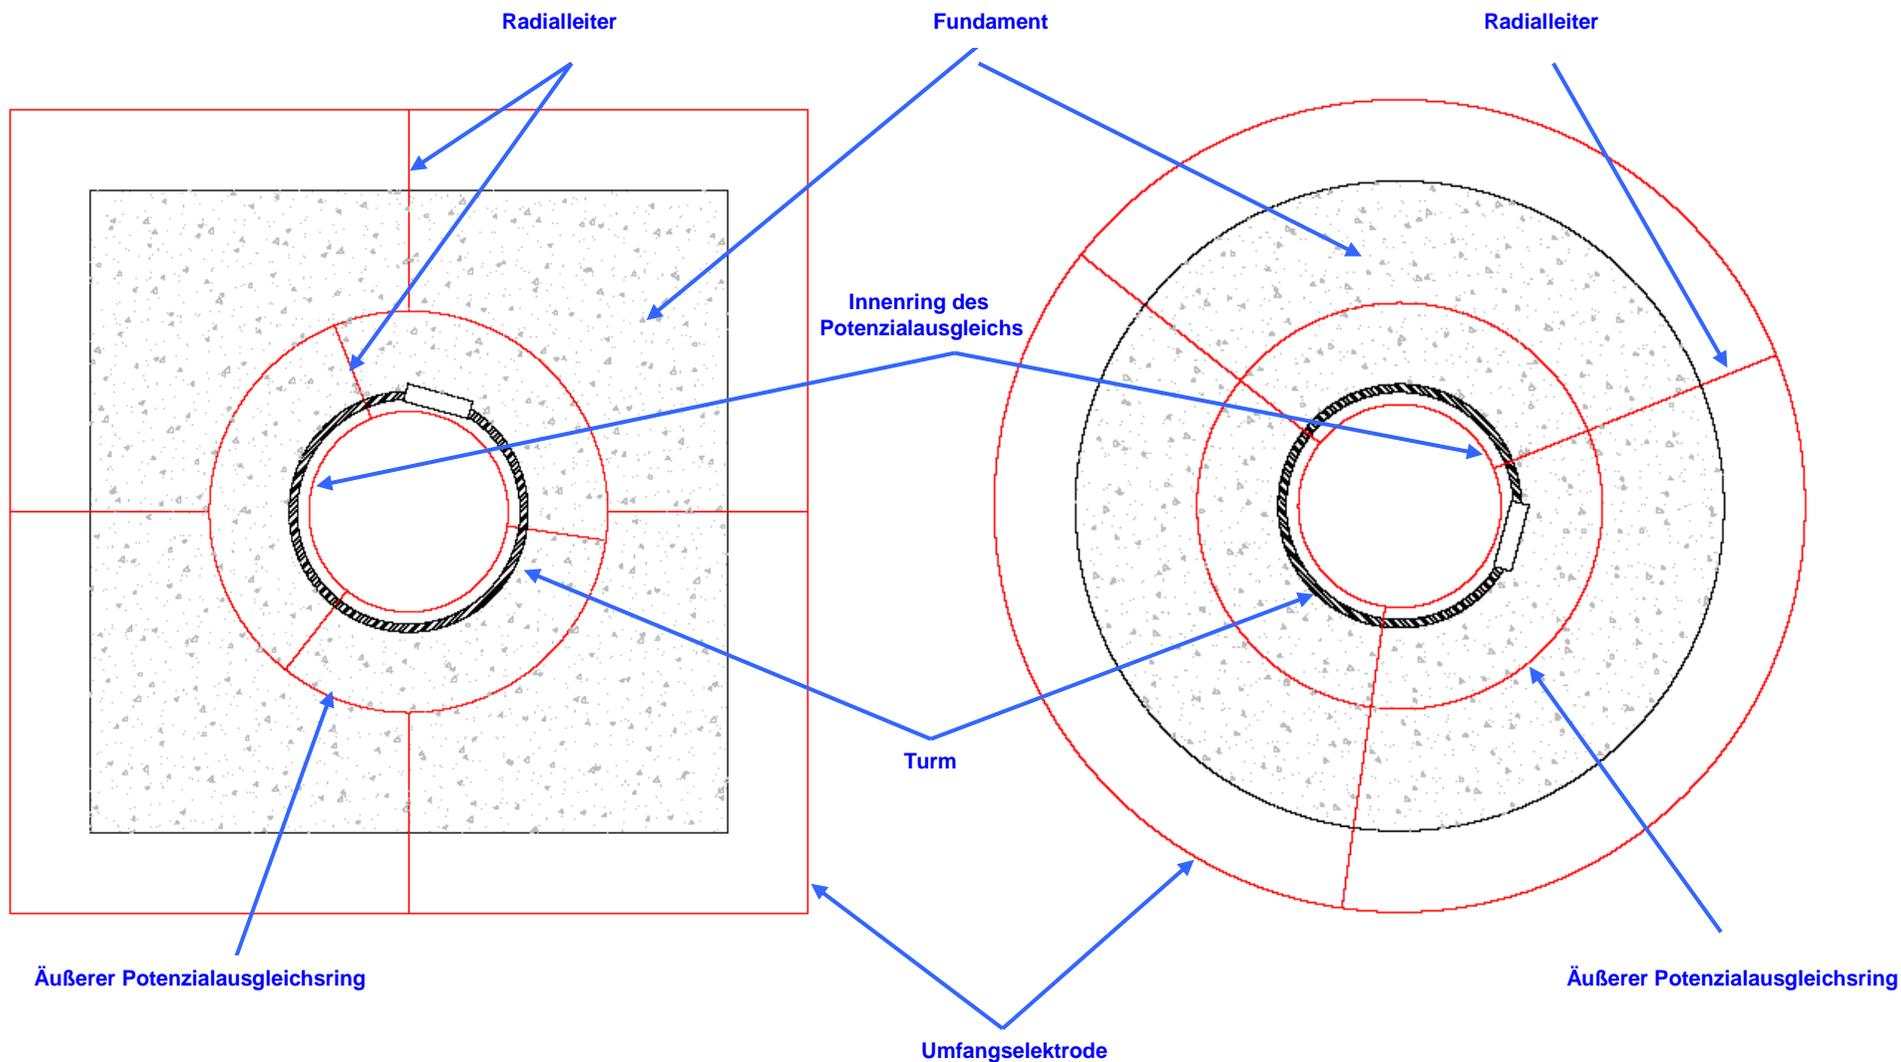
Elemente einer Erdungsinstallation vom Typ
